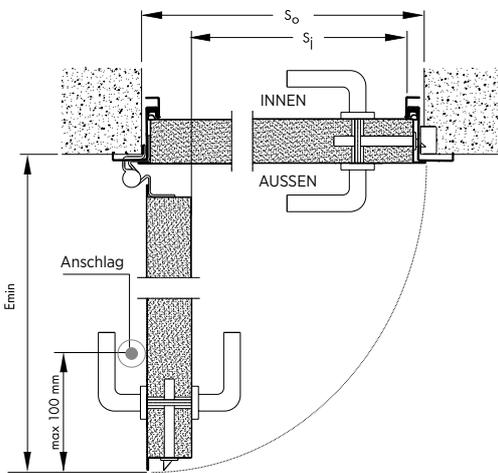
Montage vor der Öffnung - Horizontalschnitt.
